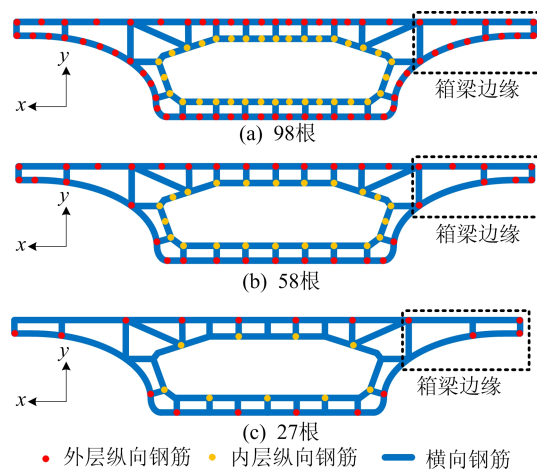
3 种纵向钢筋数量箱梁纵向钢筋布置示意图
